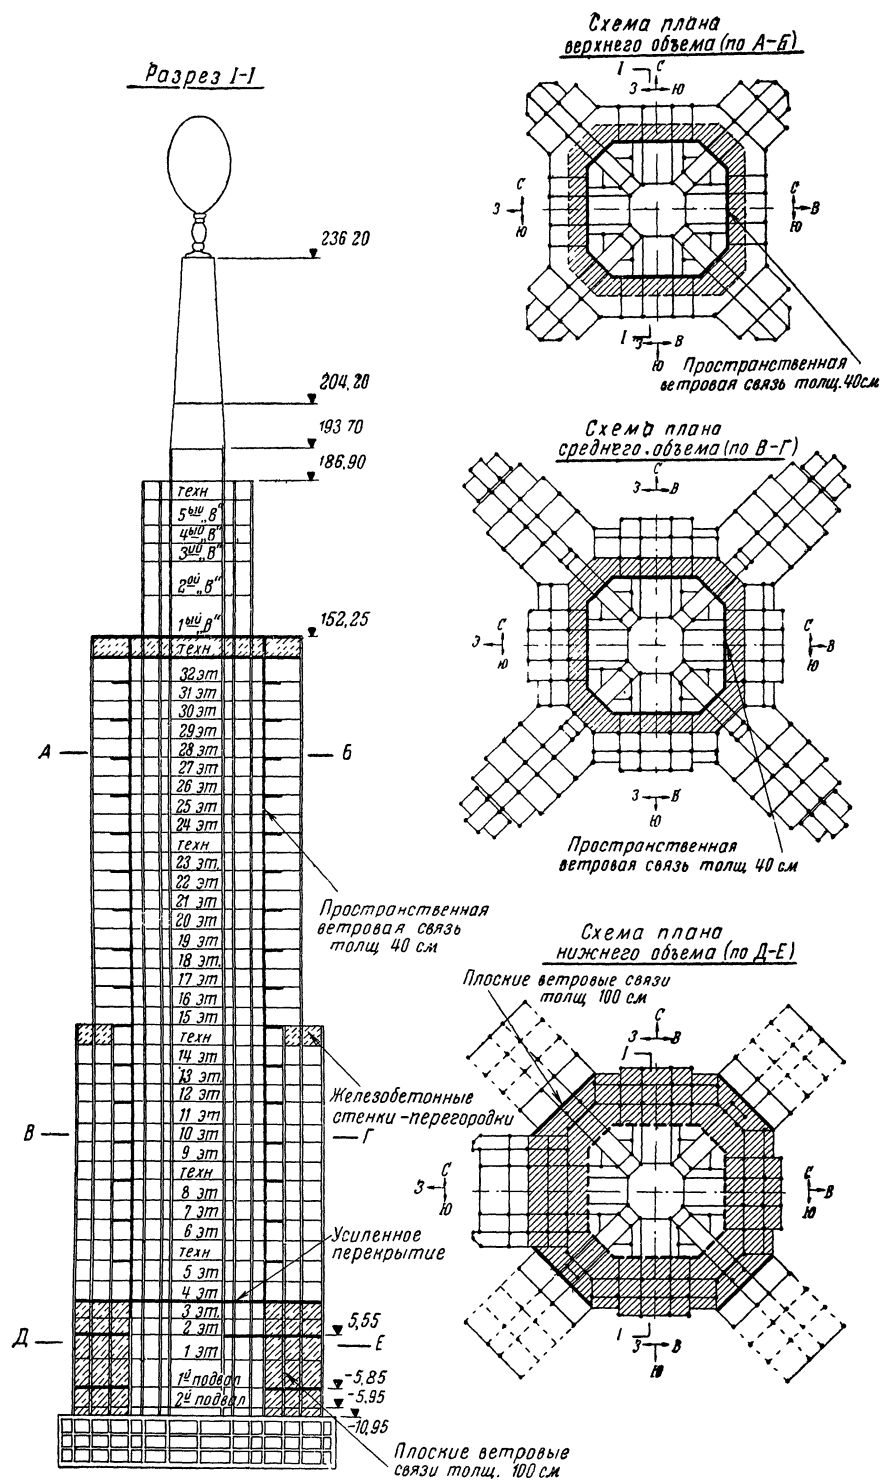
Схема пространственной железобетонной конструкции ветровых связей. Второй вариант
